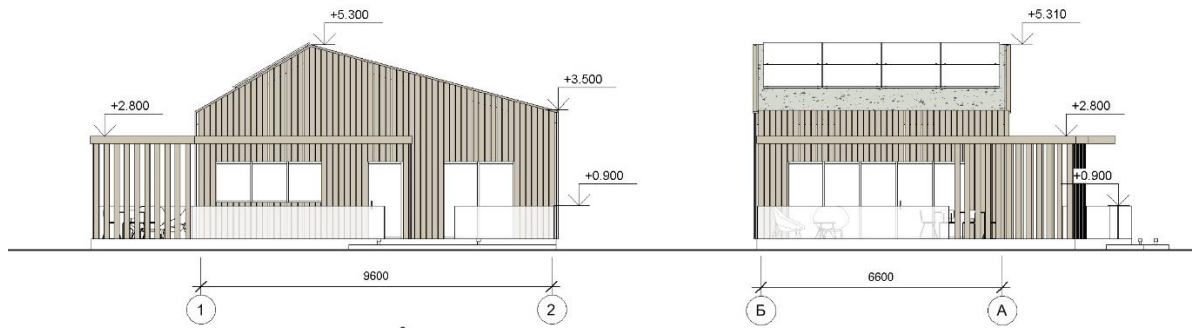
Фасад в осях 1-2, фасад в осях Б-А
